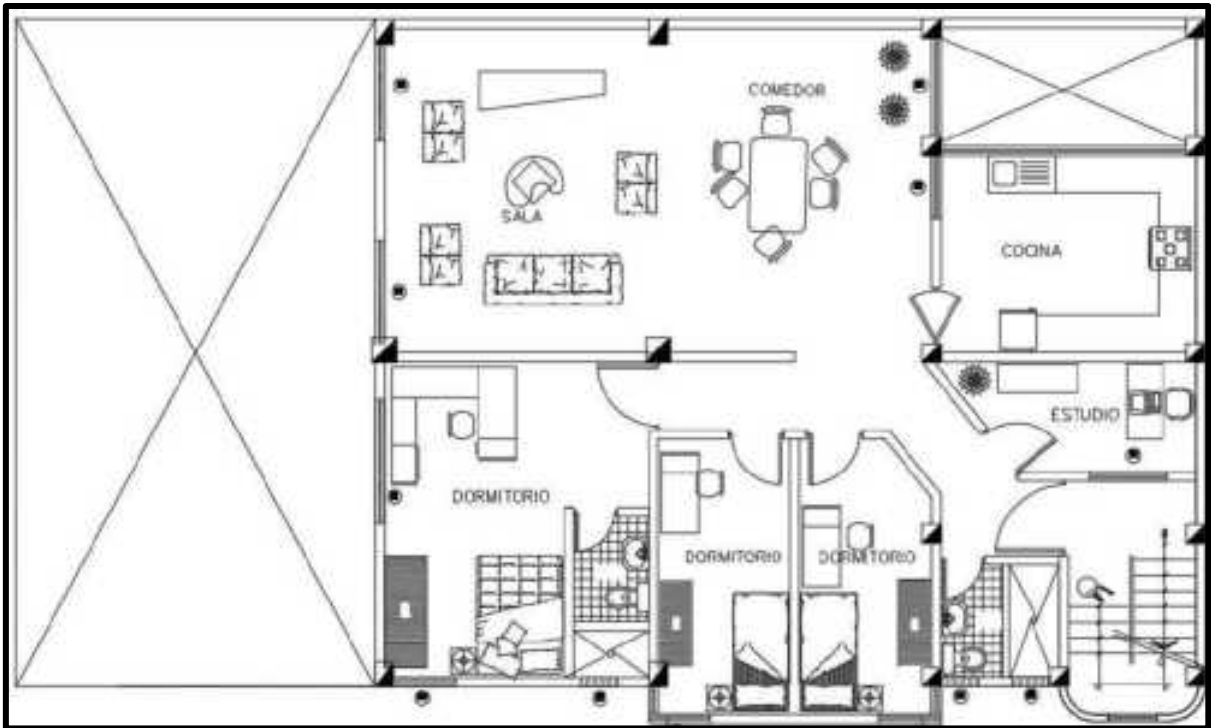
Planta típica del 2do al 4to nivel de la edificación en proyección
